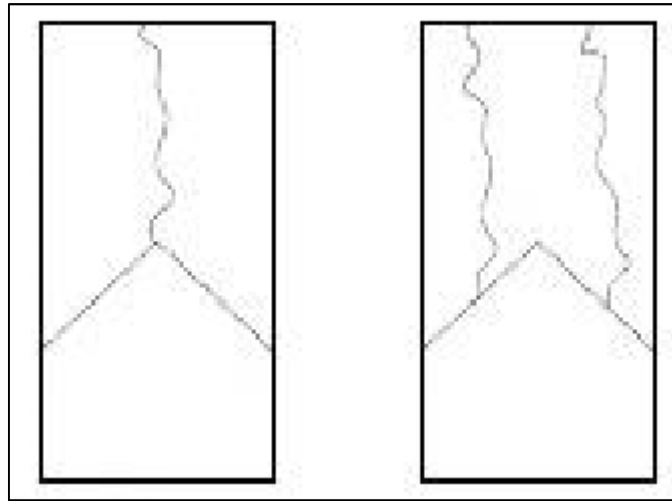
Fractura tipo II. Fuente. NTP 339.034 / ASTM C-39
